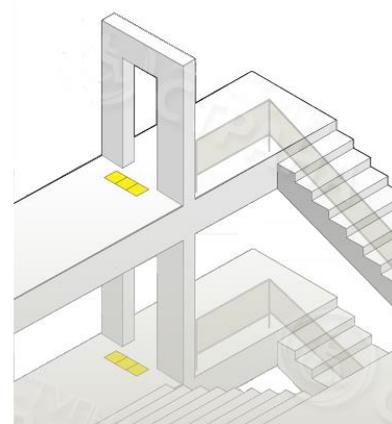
Лестница с открытыми выходами на площадках
